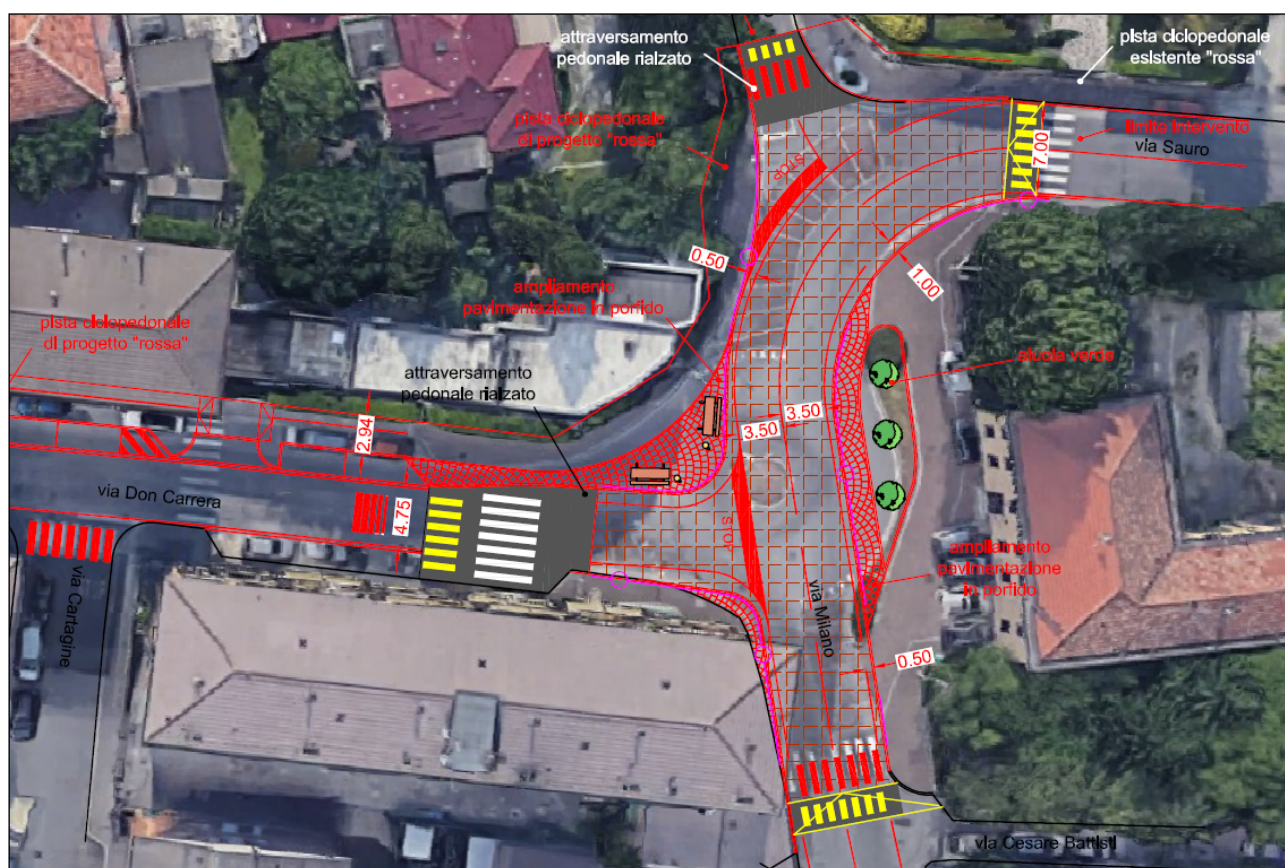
Ridefinizione dell'intersezione tra via Milano e via Don Carrera
